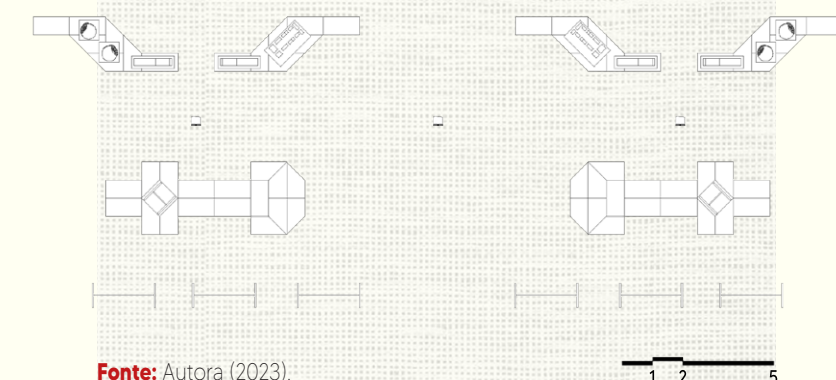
Planta baixa laboratório de pesquisa tamanho 1
